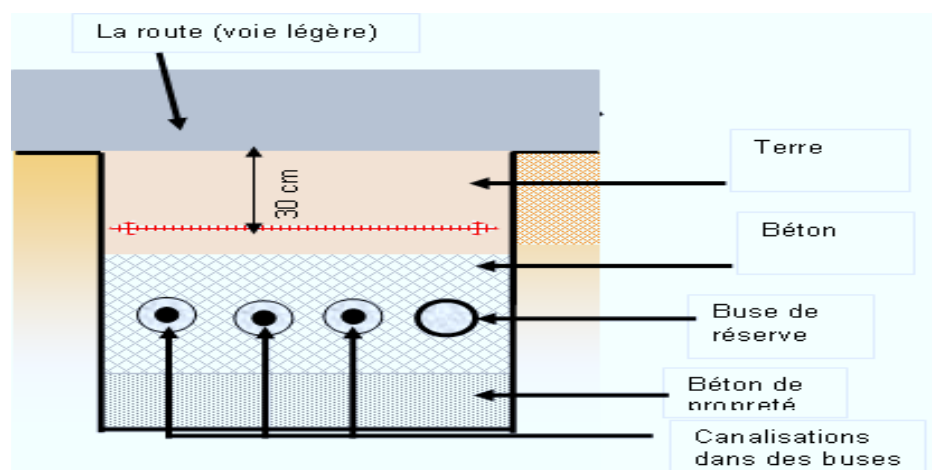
Pose du câble à la traversée de voie piétonne
